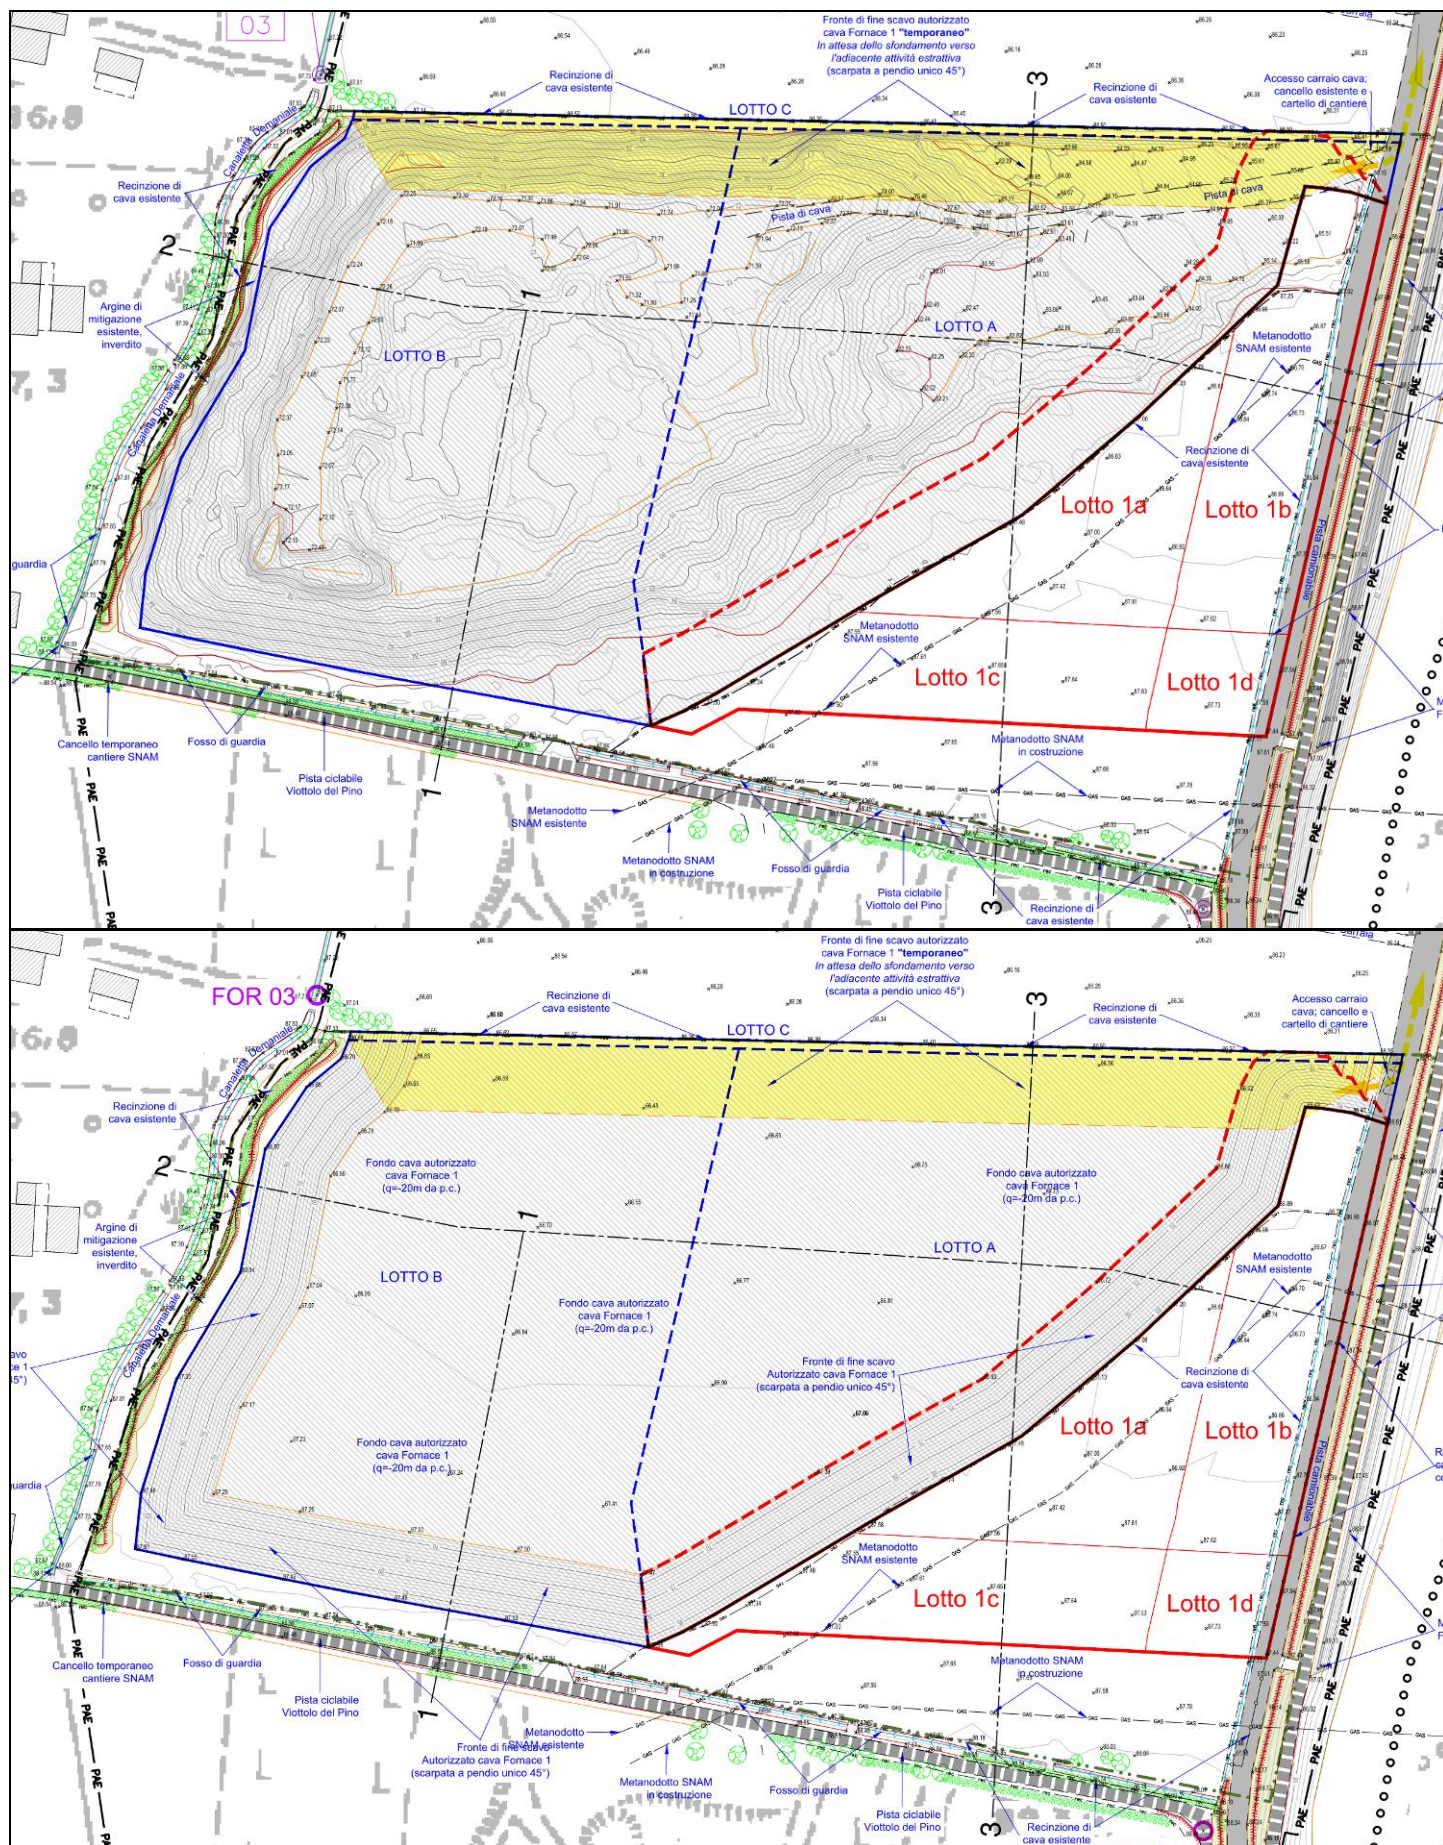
Stralcio della Tav. 02 “Stato di Fatto – Planimetria di rilievo del 16/06/2025” (in alto) e Tav. 03 “Stato di Fatto – Planimetria Stato di Fatto Autorizzato di Fine scavo Fornace-1” (in basso).
